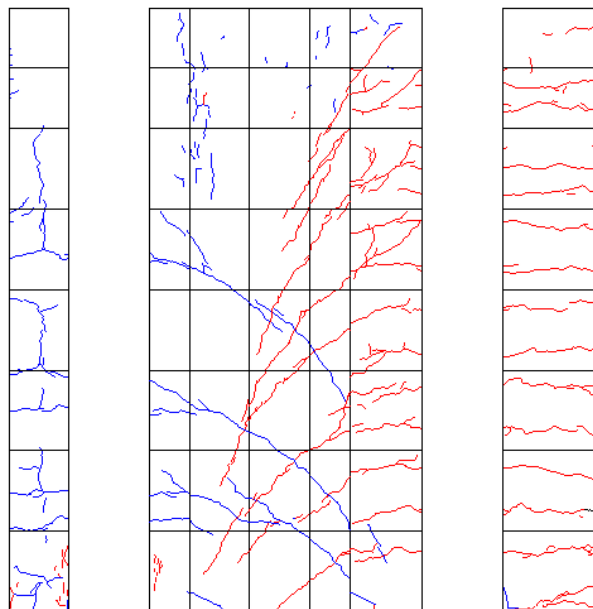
R=-1/100 ひび割れ図
